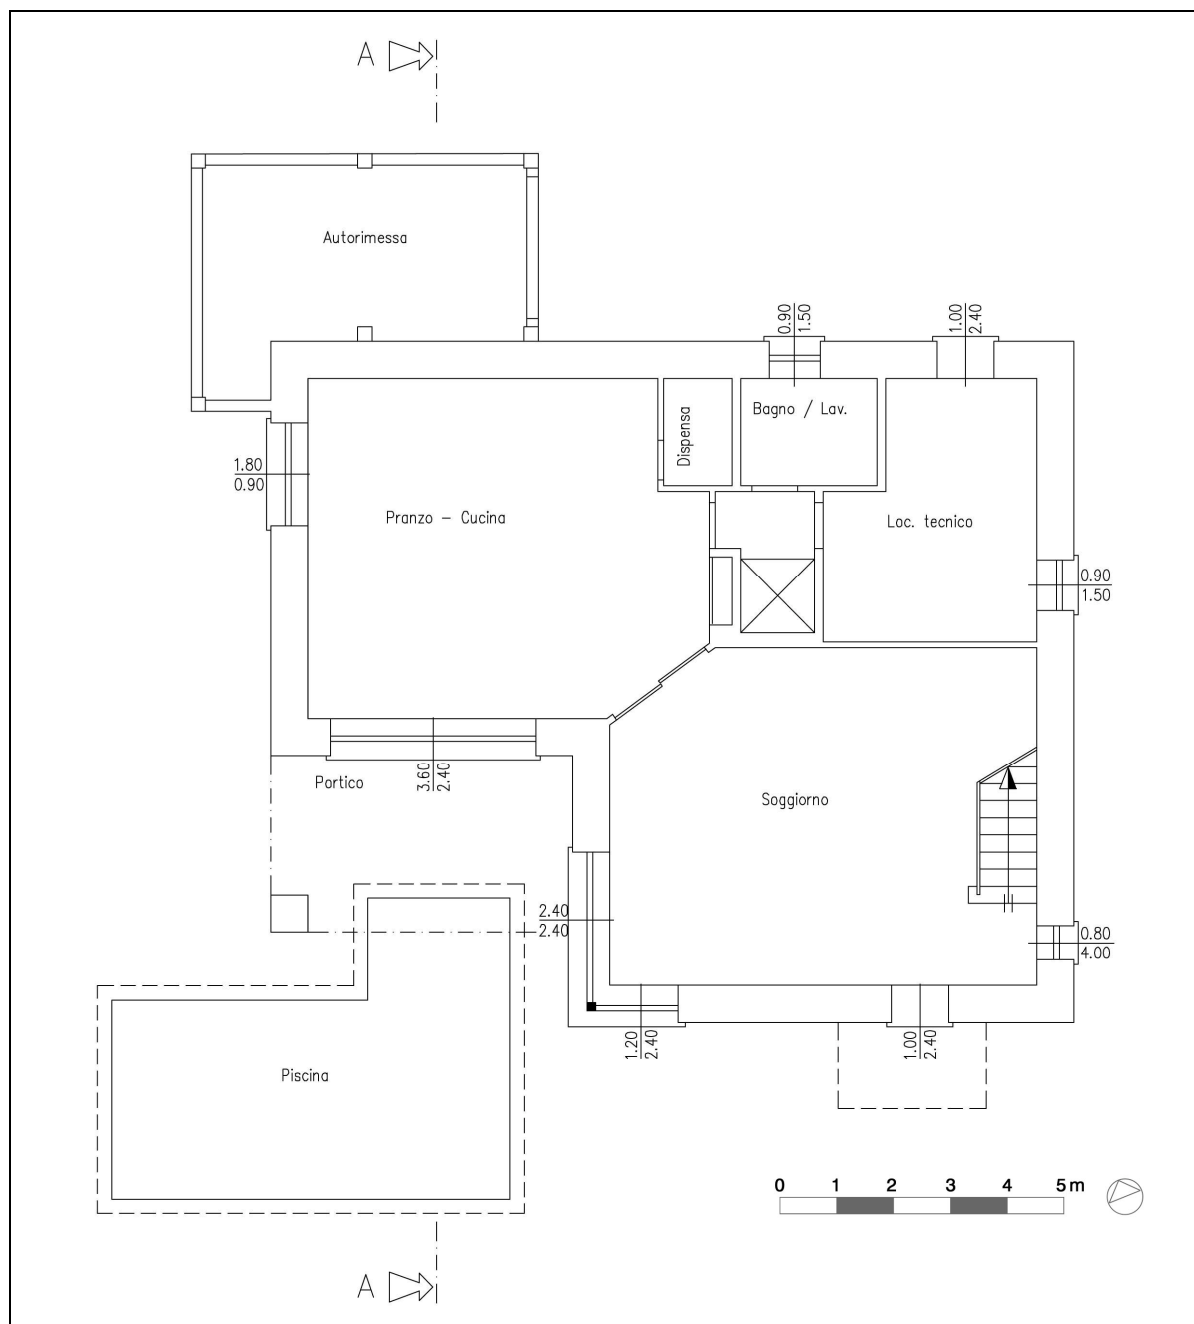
Pianta del piano terreno della casa passiva di Carpi.
